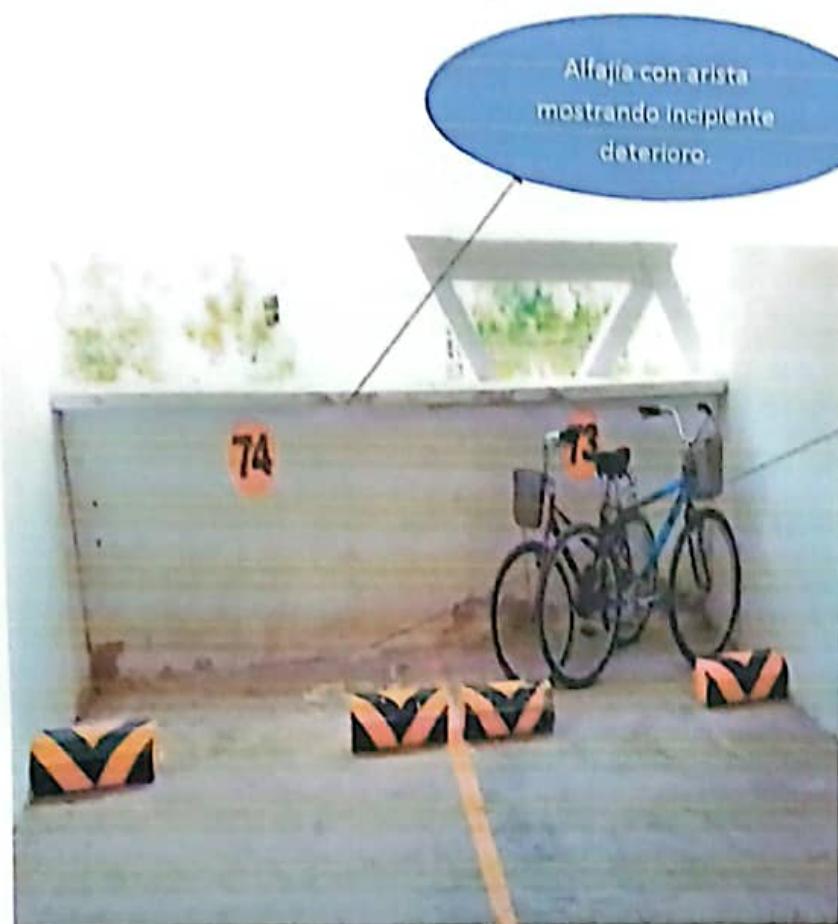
se puede apreciar localización puntual longitudinal de eflorescencias y deterioro en pañete o recubrimiento de características poroso por defectos constructivos y la no aplicación de impermeabilizantes, esto unido a exceso de agua de amasado. Se puede apreciar deterioro de la alfaja remate del antepecho del muro.
